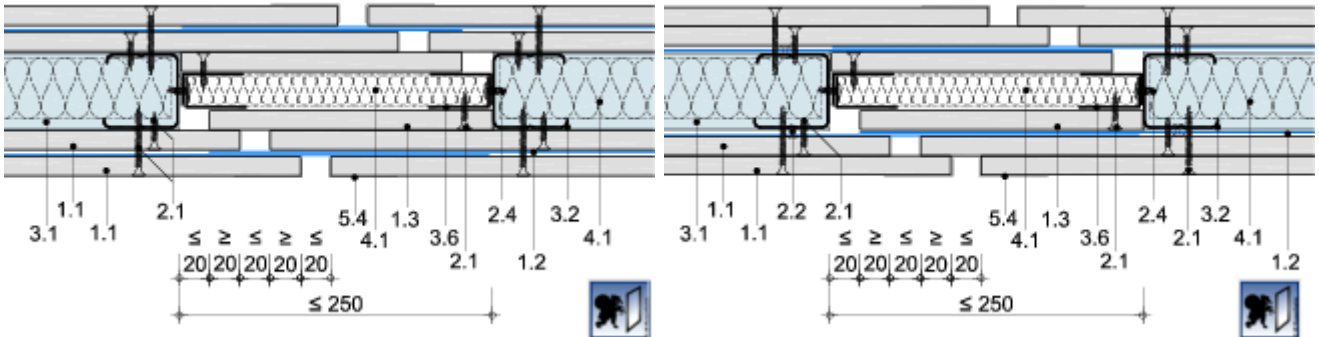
Trennwandanschluss Doppelständerwand RC 2 mit erhöhtem Schallschutz
